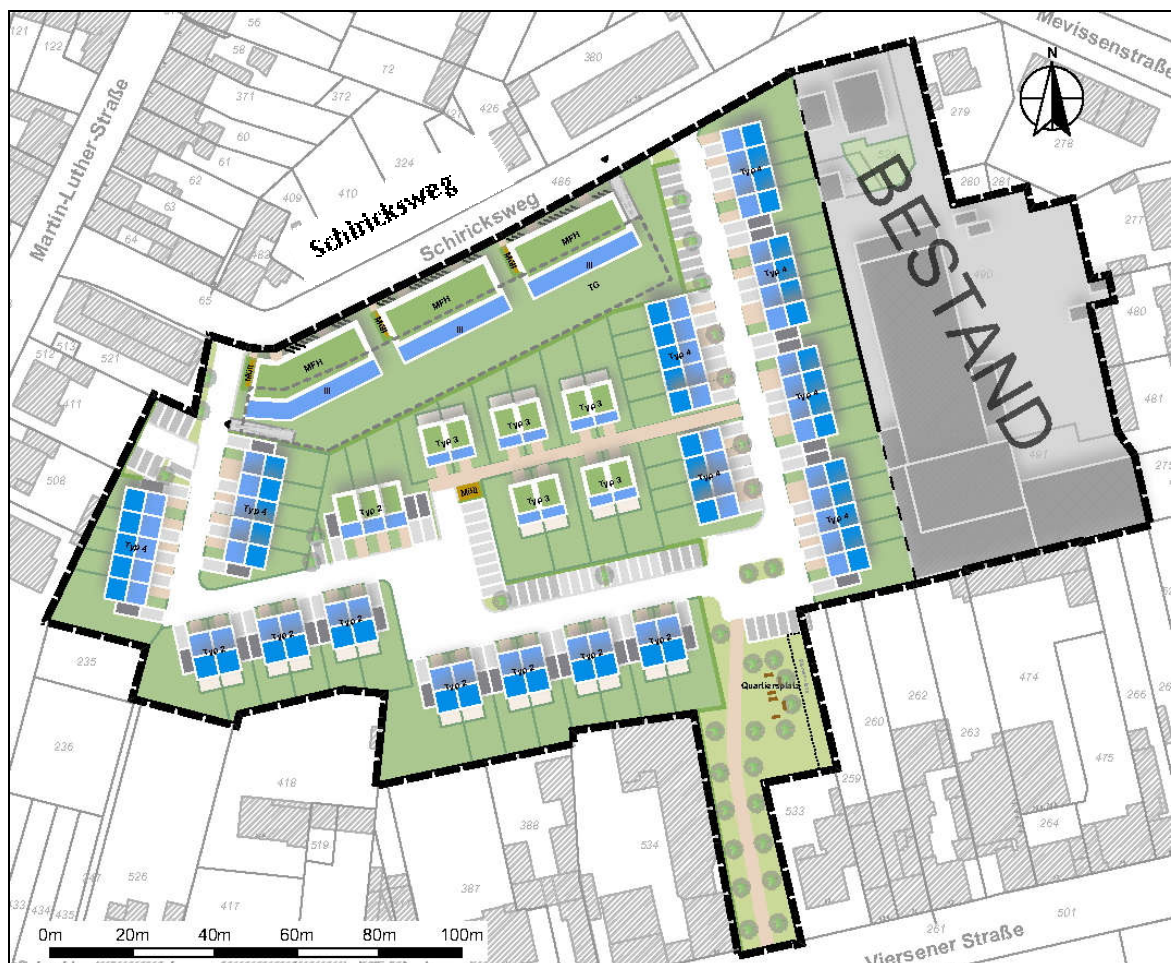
Städtebaulicher Entwurf Bebauungsplan Schiricksweg
